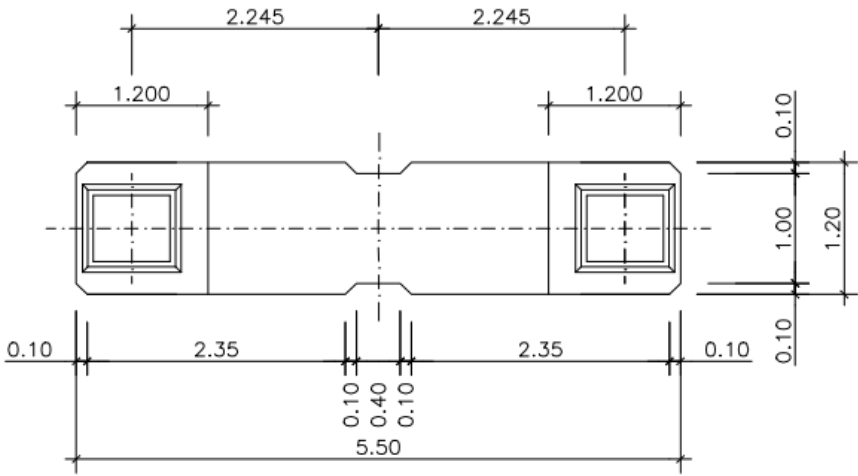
Sección tipo de pilas P.S. 9.7
